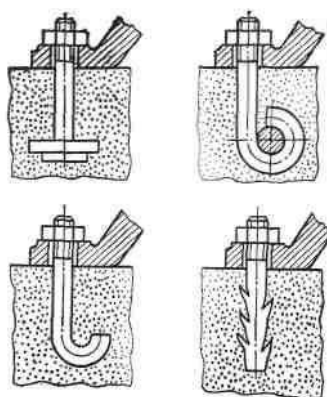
Фундаментные болты прямо на полу их вовсе не закрепляют или закрепляют цементным раствором, эпоксидным или другим клеем.
